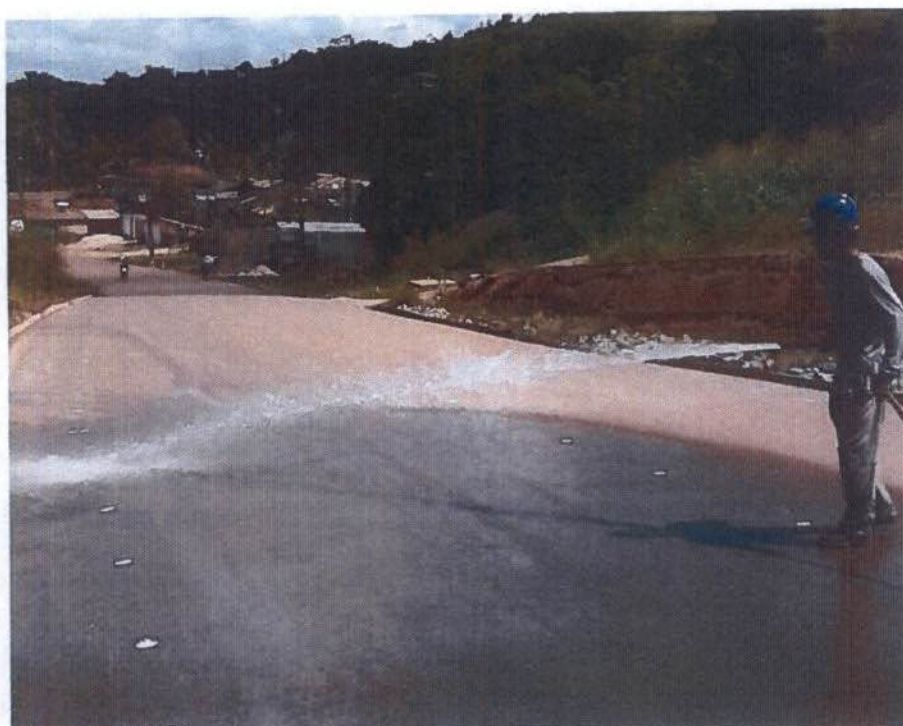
Limpeza da pavimentação para pintura da pista, (lado Belo Monte do Pontal).
